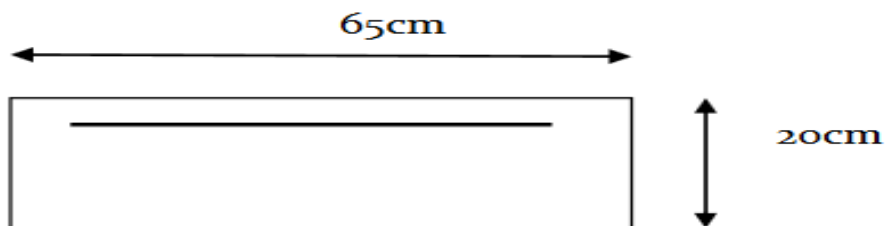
coupe schématique de la poutrelle (travée)
